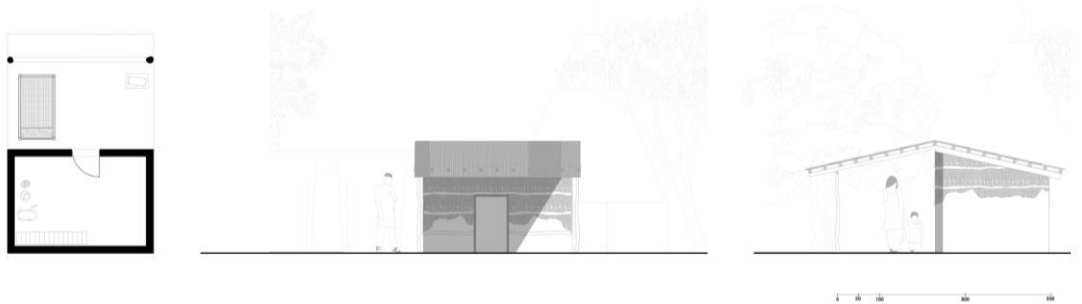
Grundriss und Schnitt, Rechteckiges Haus 1 (Quelle: Windisch, 2023)
